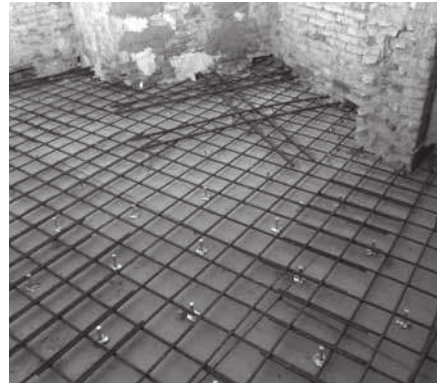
Vista de los conectores y la armadura de la capa de compresión antes del vertido del hormigón.
